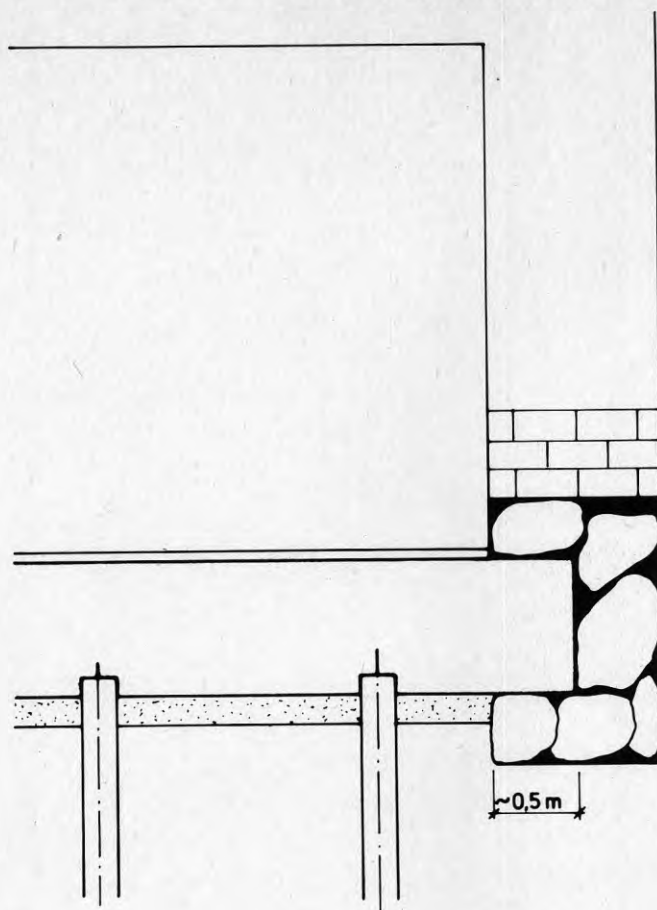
Betongplattans anslutning till befintliga grundmurar, princip.
